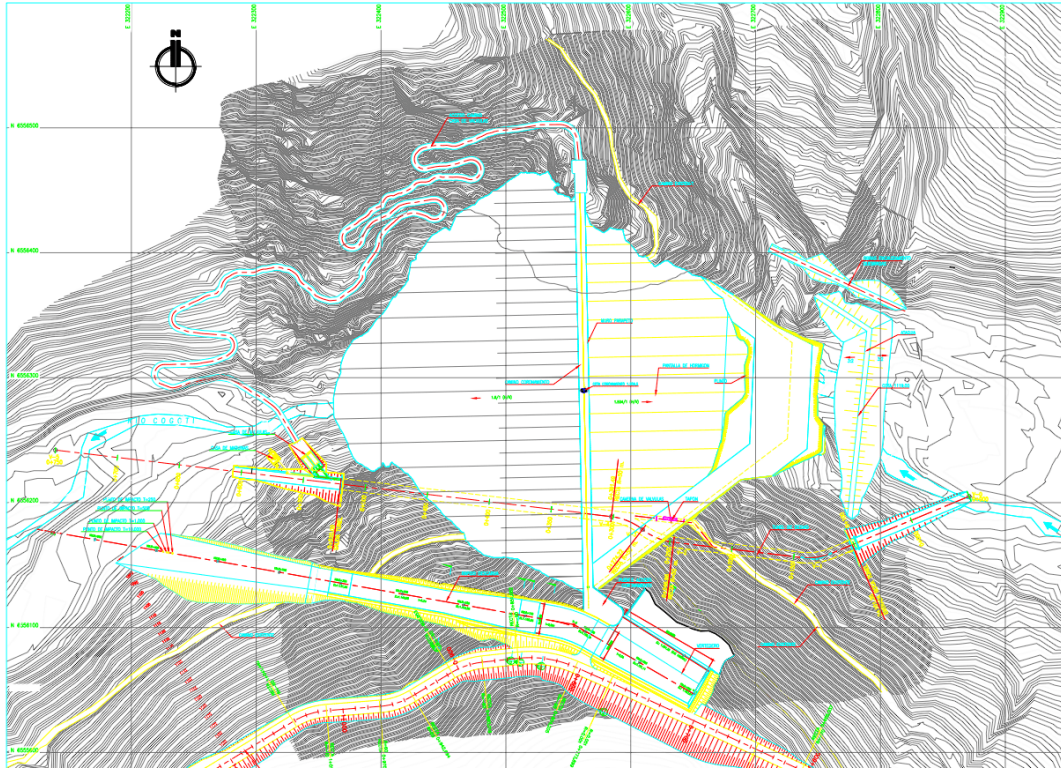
Planta Presa CFRD La Tranca, Fuente: E.F MN Ingenieros
